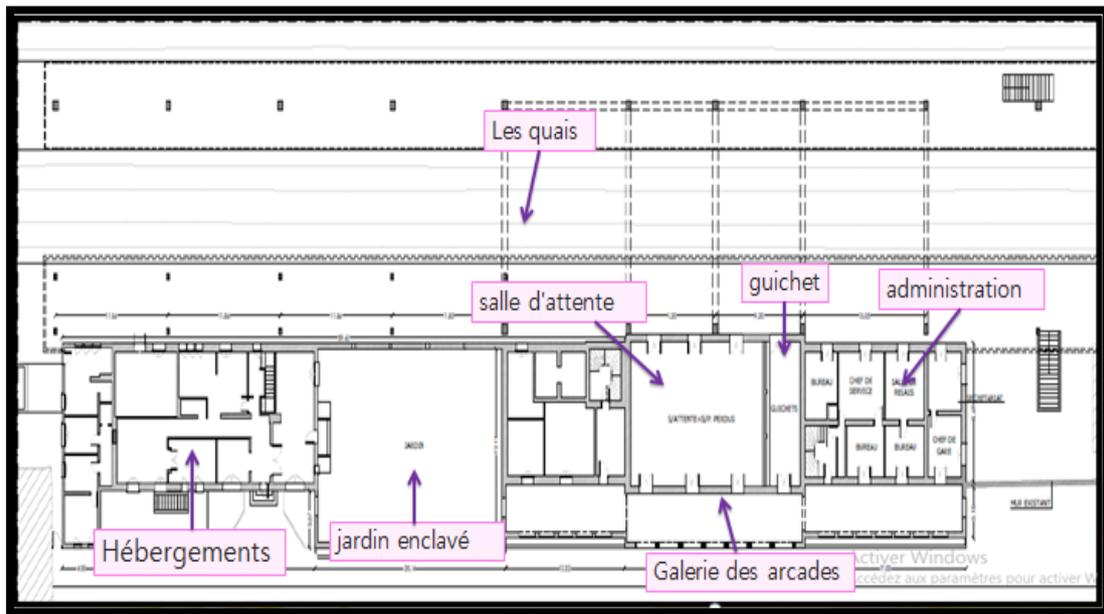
Plan RDC de la gare ferroviaire de Tlemcen
